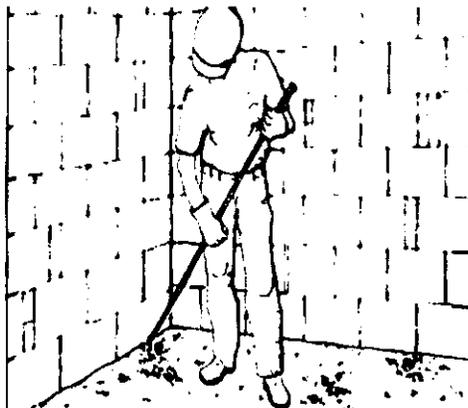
Remoção de detritos aderidos a laje utilizando um vanga ou ponteira e picão e marreta.
